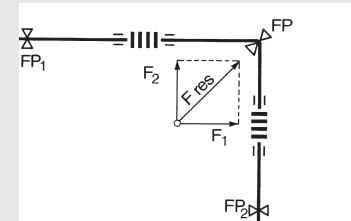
Изгиб трубопровода с осевыми компенсаторами и коленчатой опорой.
